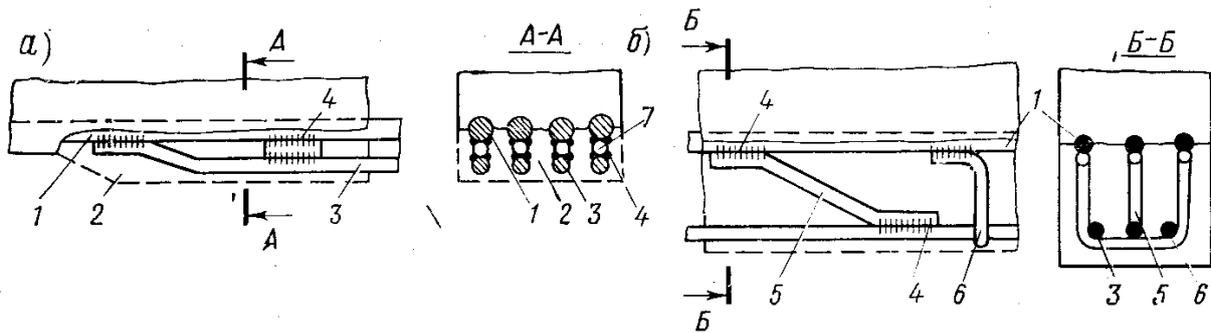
Усиление железобетонных балок путем постановки дополнительной арматуры:
